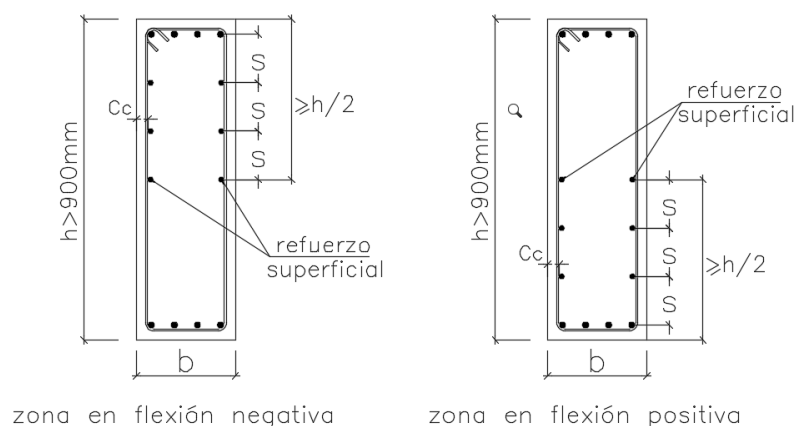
Refuerzo superficial en vigas con peralte mayor a 900 mm.
